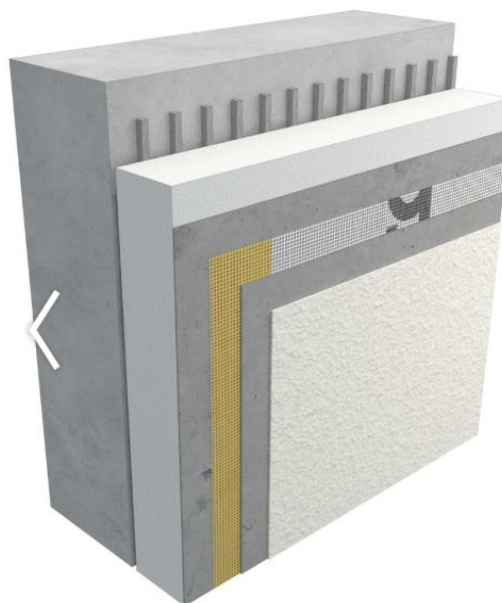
Detalle constructivo muros exteriores. Fuente: www.plataformaarquitectura.cl
